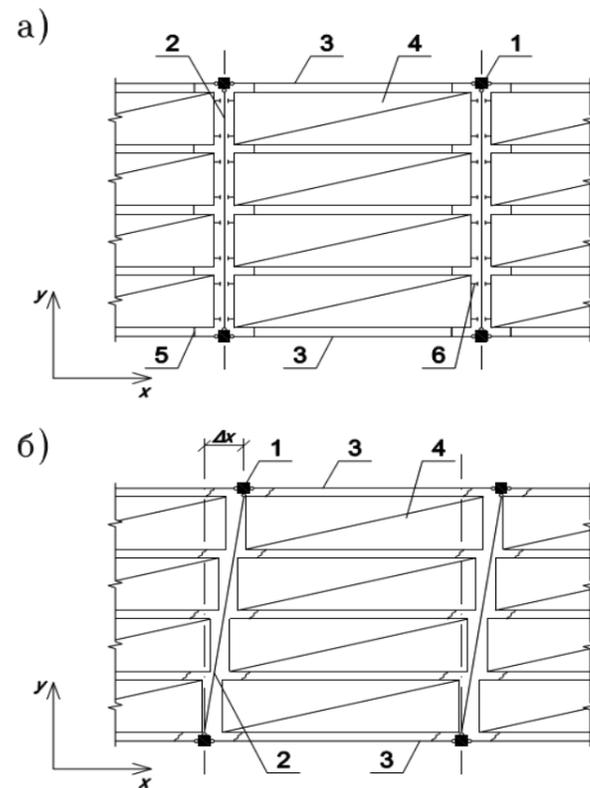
Фрагмент расчетной модели каркаса с дисками перекрытий. а) в исходном состоянии; б) фрагмент, деформированный в направлении оси X. 1- колонна, 2 - ригель, 3 - связевая балка, 4 – перекрытие, 5 - сдвиговая связь в швах плит, 6- упоры
